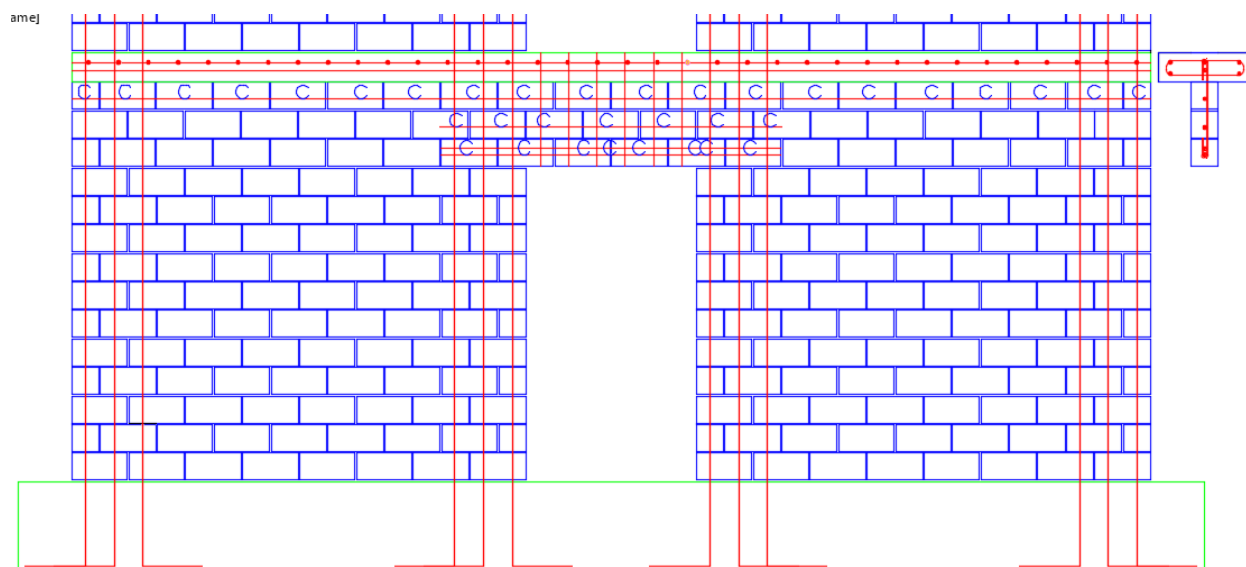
Detalhe dos linteis de alvenaria armada sobre as aberturas de porta
